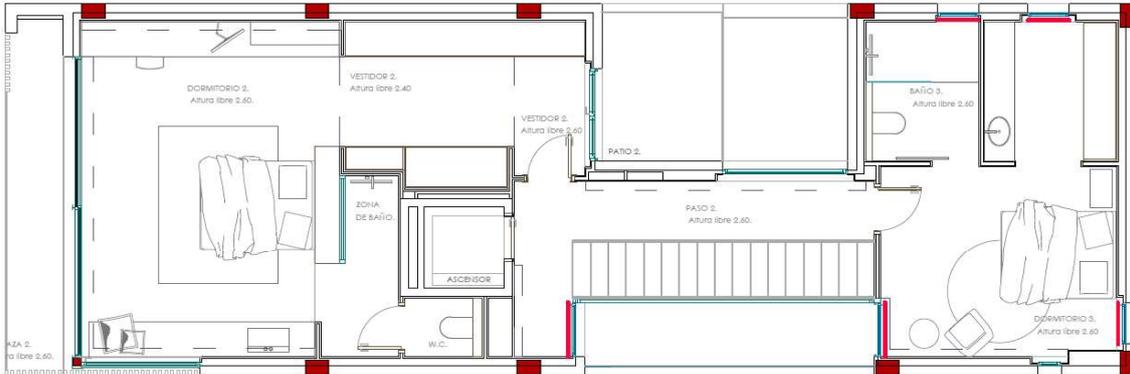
Plano de la Planta Segunda de la vivienda. Vista: En Planta
